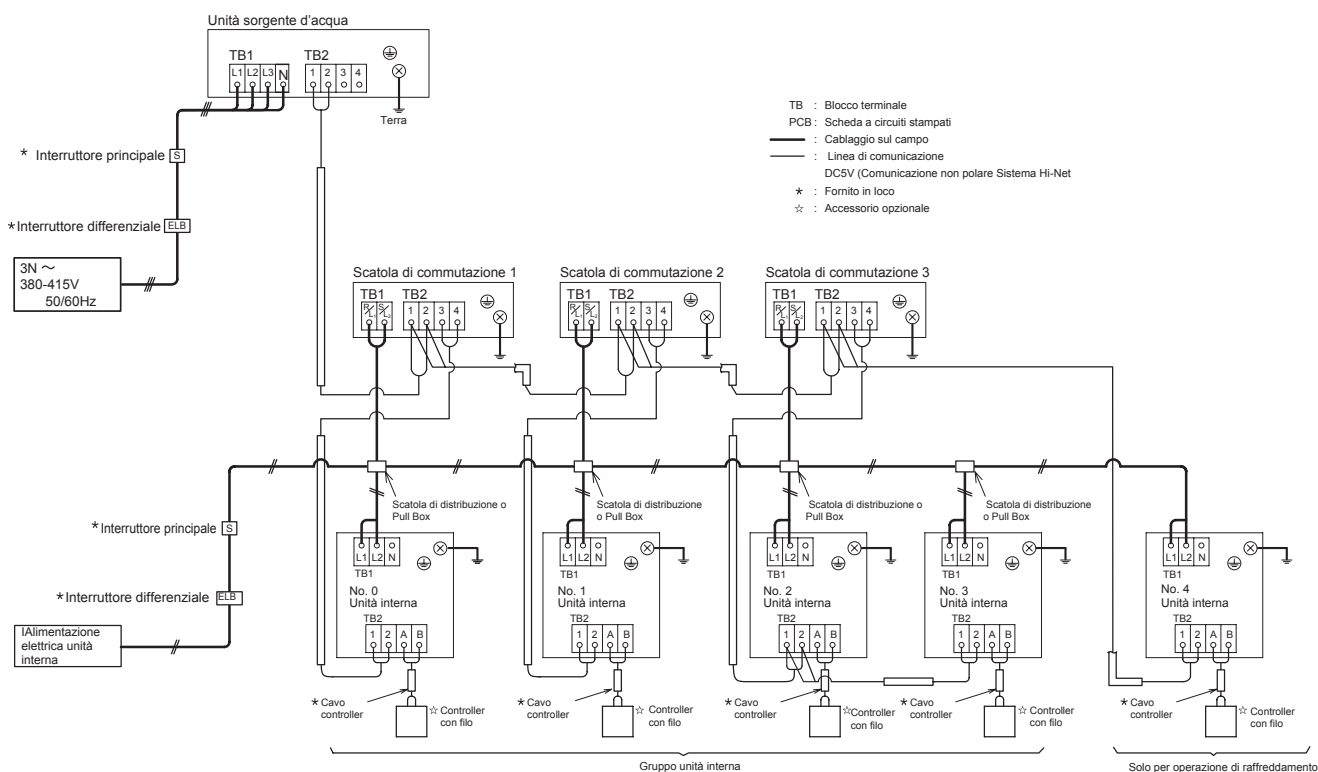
Layout per connessione di cablaggio elettrico (Sistema a recupero di calore)
